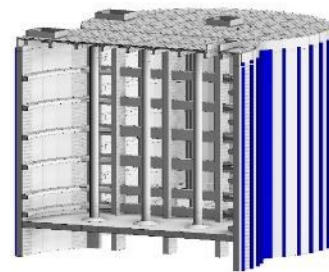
Corte transversal da estrutura do reservatório após execução da estrutura da cobertura.
